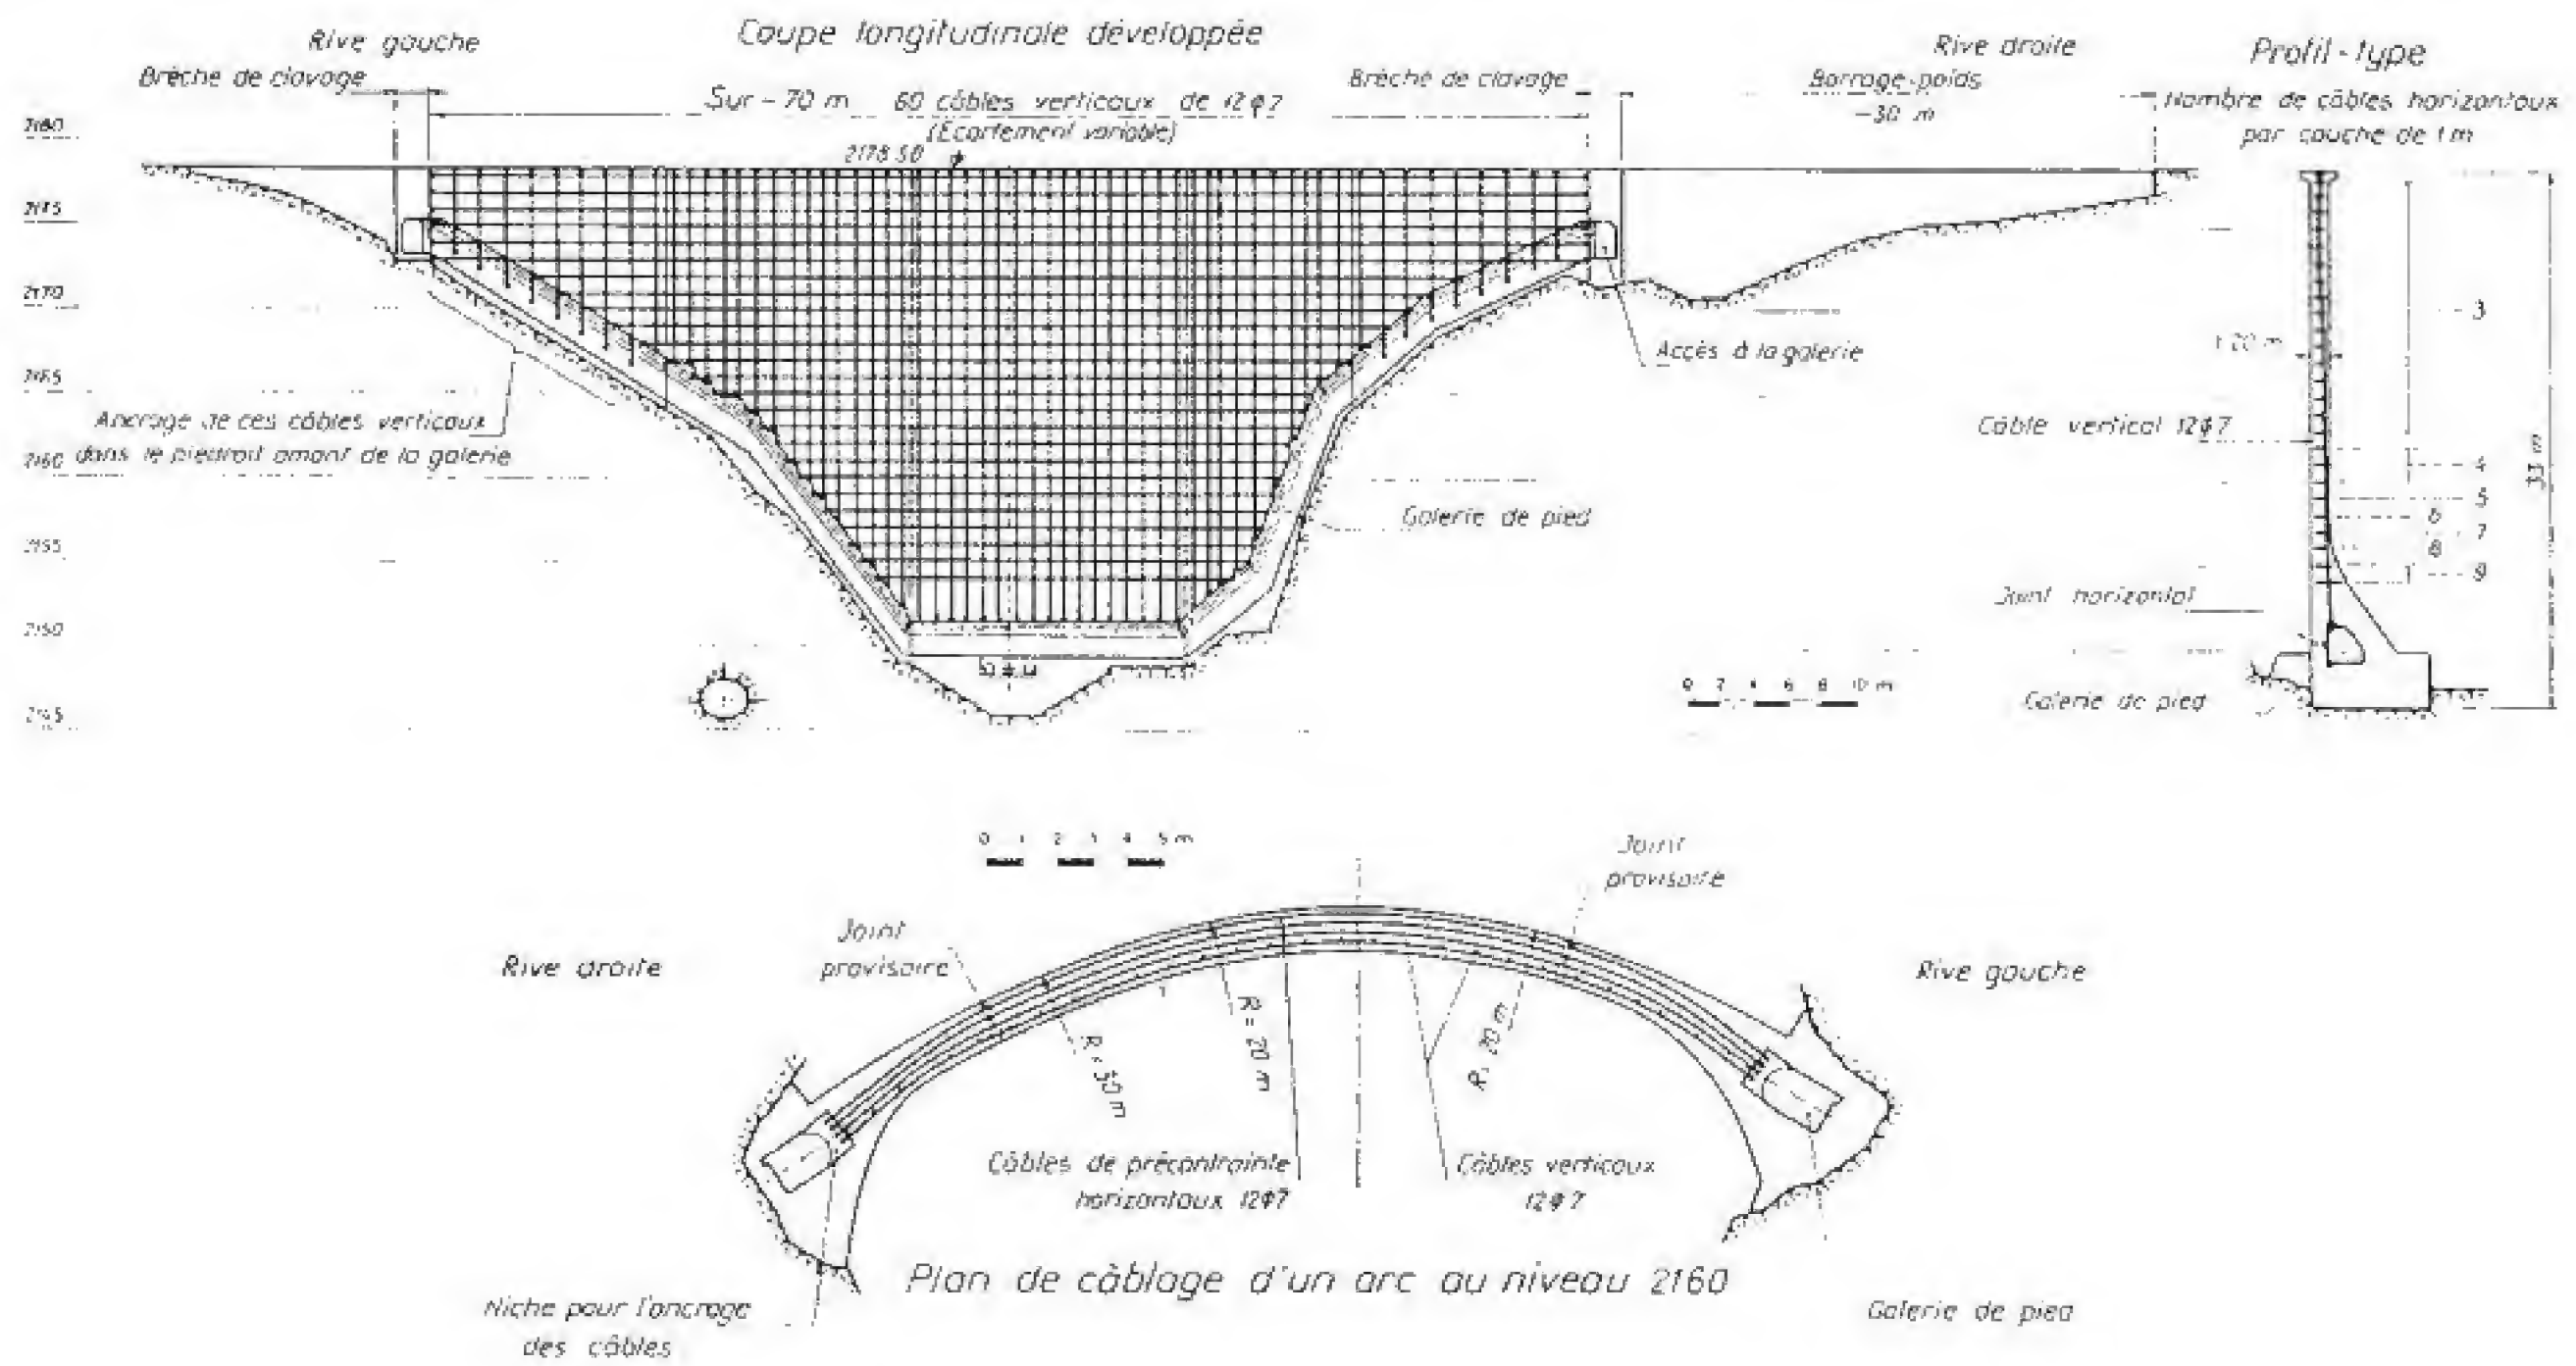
Barrage de Tourtemagne: câblage dans une coupe longitudinale développée et en coupe horizontale (selon Panchaud, 1962).
